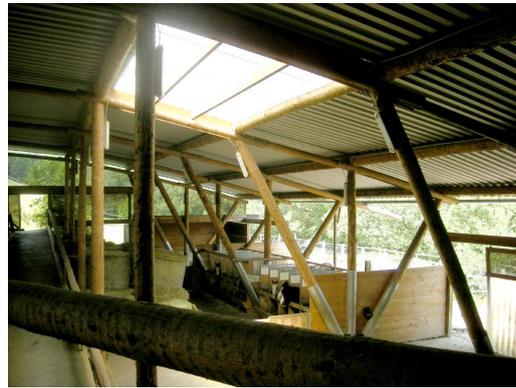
,b,c,d: Reitstall Windisch, Halle und Stall
